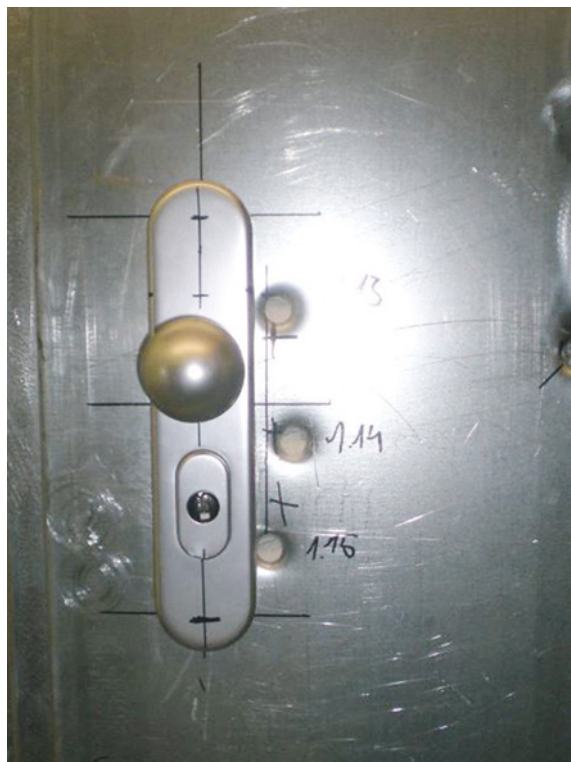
Durchschusshemmende Türe nach Beschuss am Beschlag [Quelle: Teckentrup (www.teckentrup.biz)]
